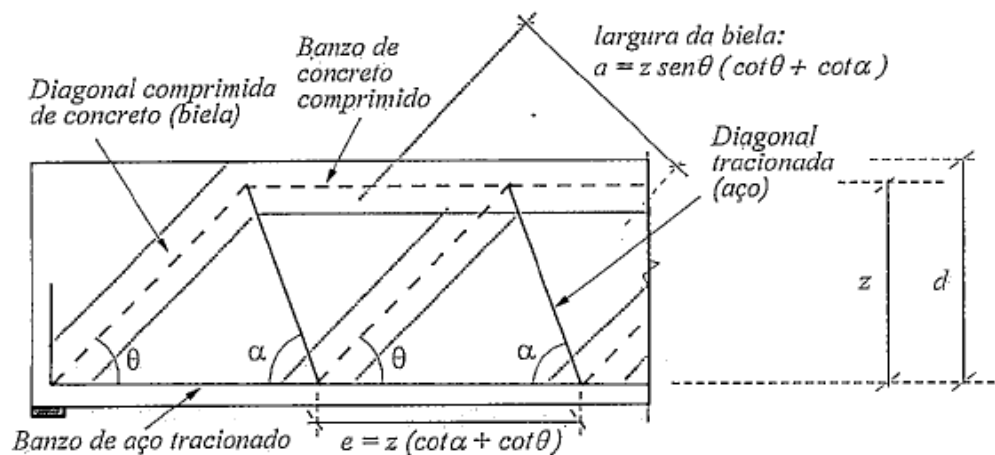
Modelo de funcionamento de uma viga de concreto segundo a treliça de Morsch (Clímaco, 2008).
